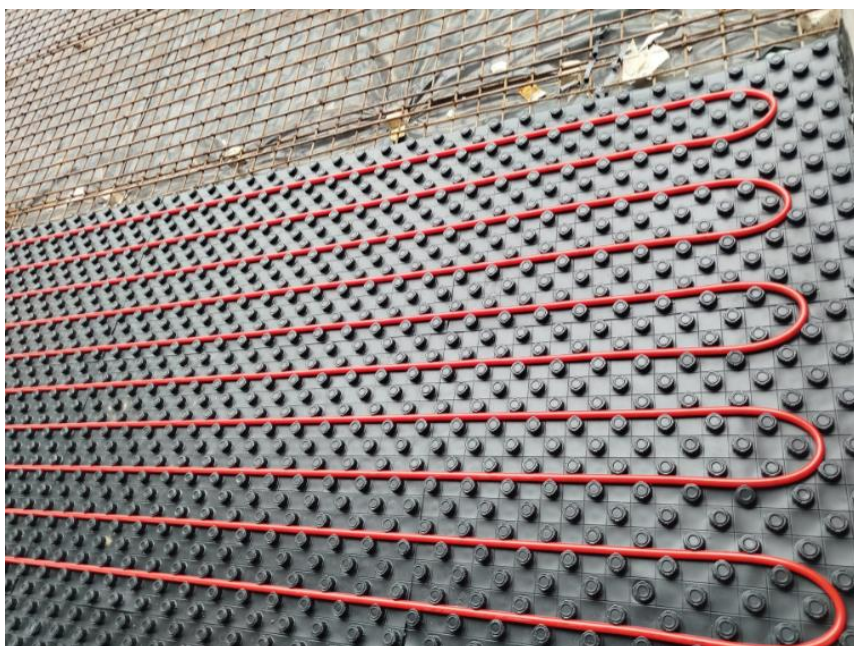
Pormenor de instalação de placa de isolamento e tubagem para piso radiante
